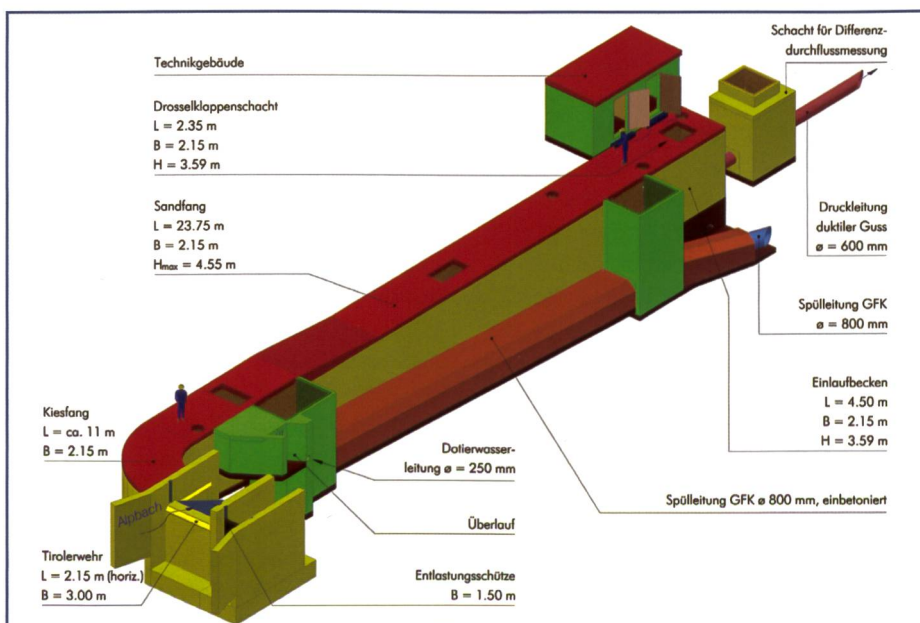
Fassung mit Beschreibung der einzelnen Bauwerksteile.
